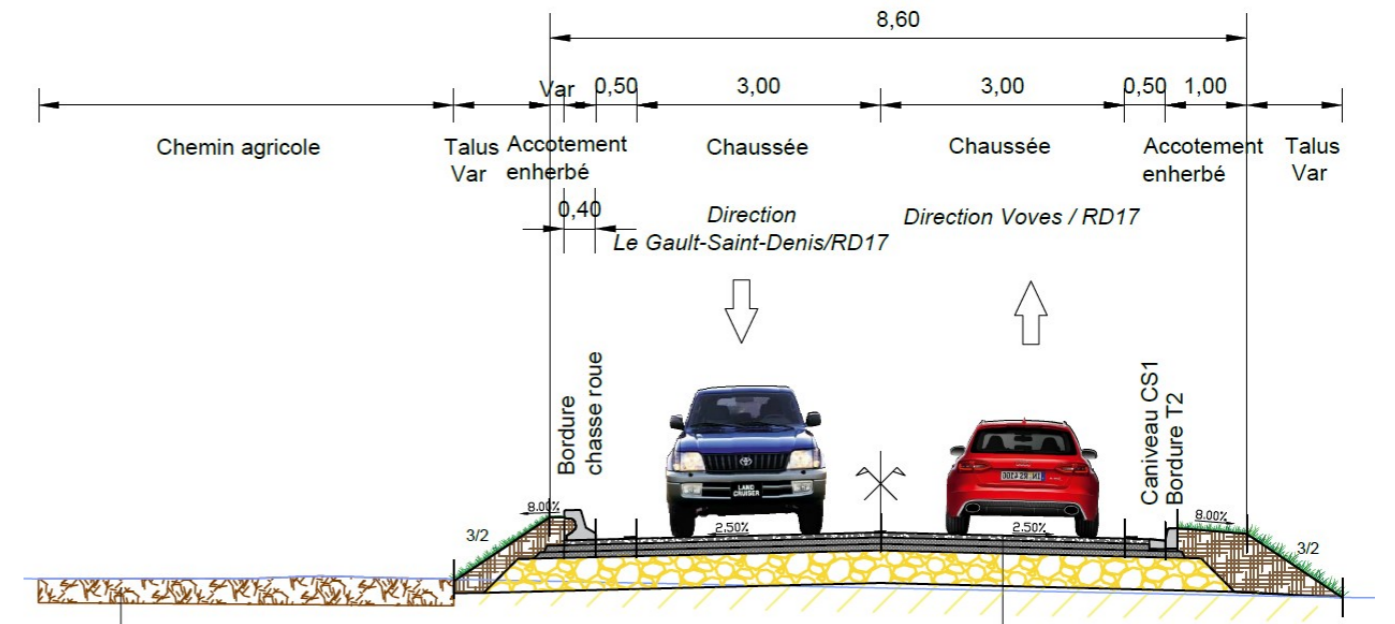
Profils en travers type de la voie nouvelle en section courante
